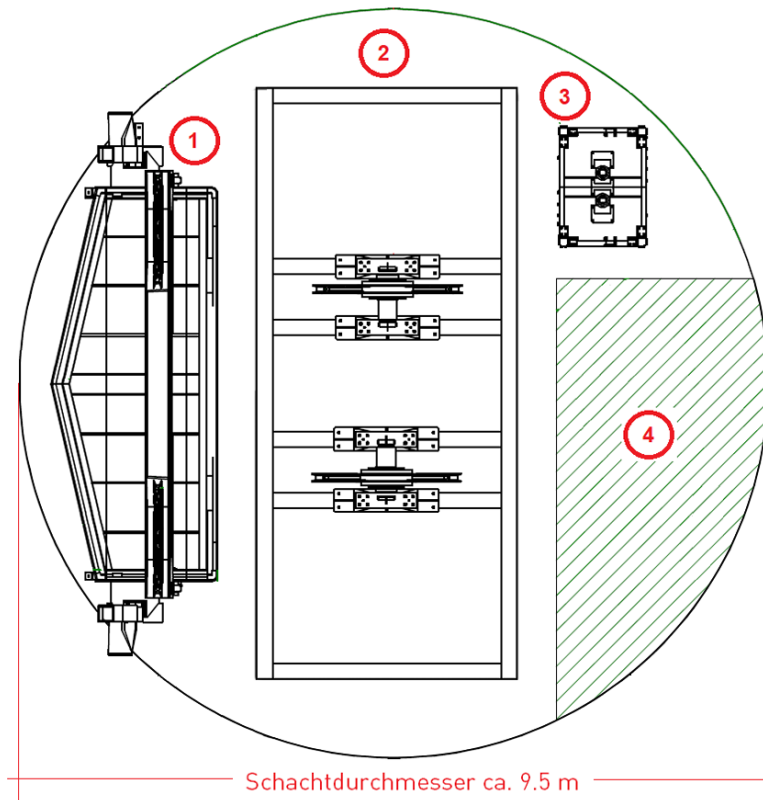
Schachtscheibe (Grundriss) eines beispielhaften Betriebsschachts
